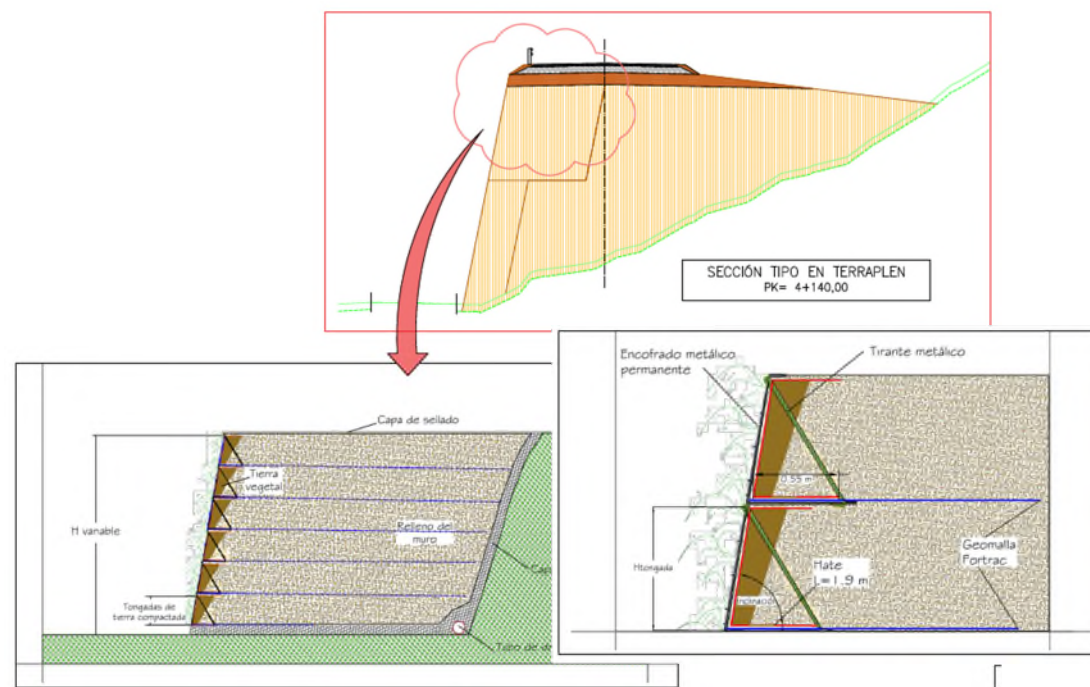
Detalles constructivos del muro verde previsto (Pueyo, 2025).
